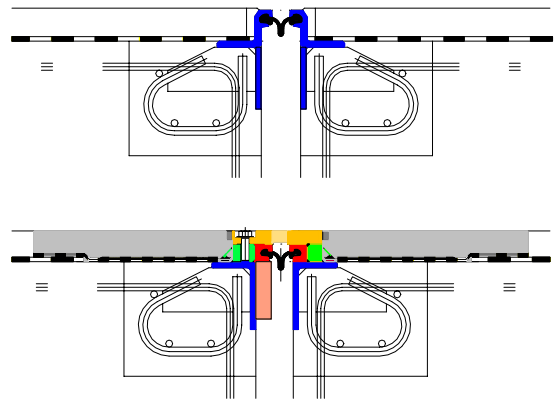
Einprofilige Dehnfugen Bestand und Nachrüstung
